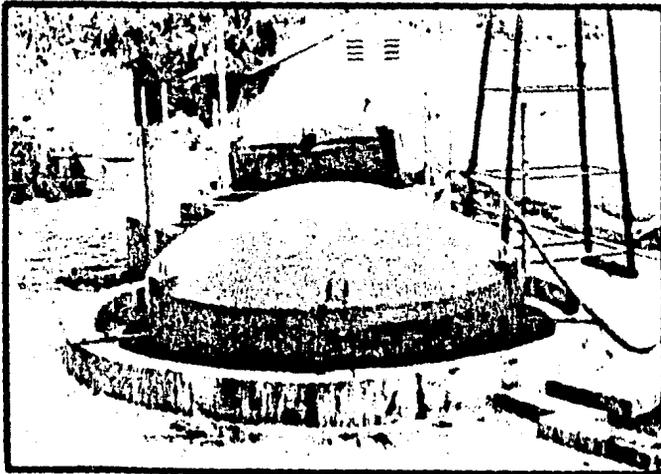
Recipientes de ferrocemento para plantas de bio gás, elaborados por el Centro de Investigación de Ingeniería Estructural, en Roorkee, India.
